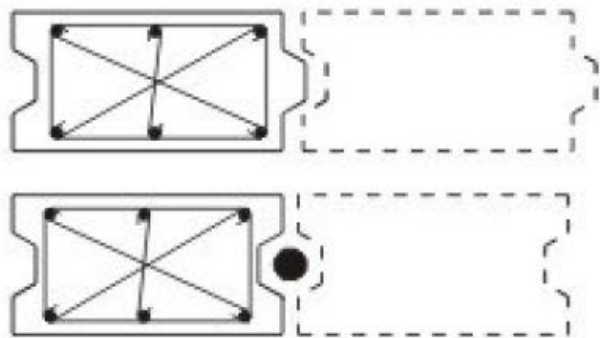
Exemple de palplanse din beton armat sau precomprimat și de tipuri de îmbinări
